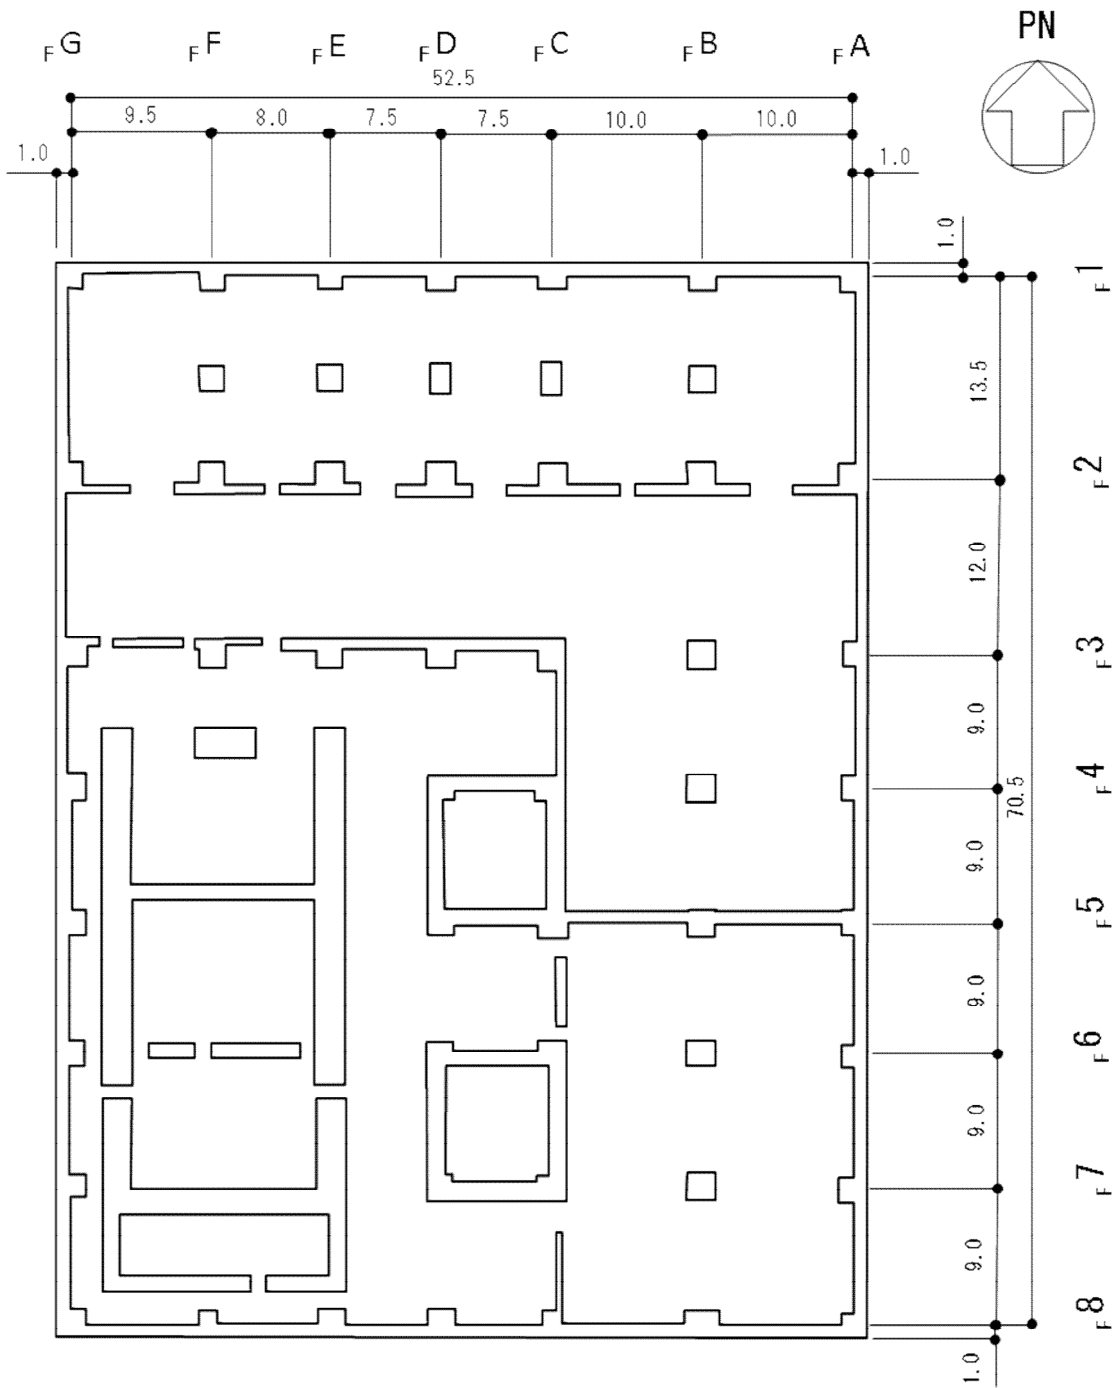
PL/B 基礎版レベル平面図(G. L. -7.3m) (単位 : m)
